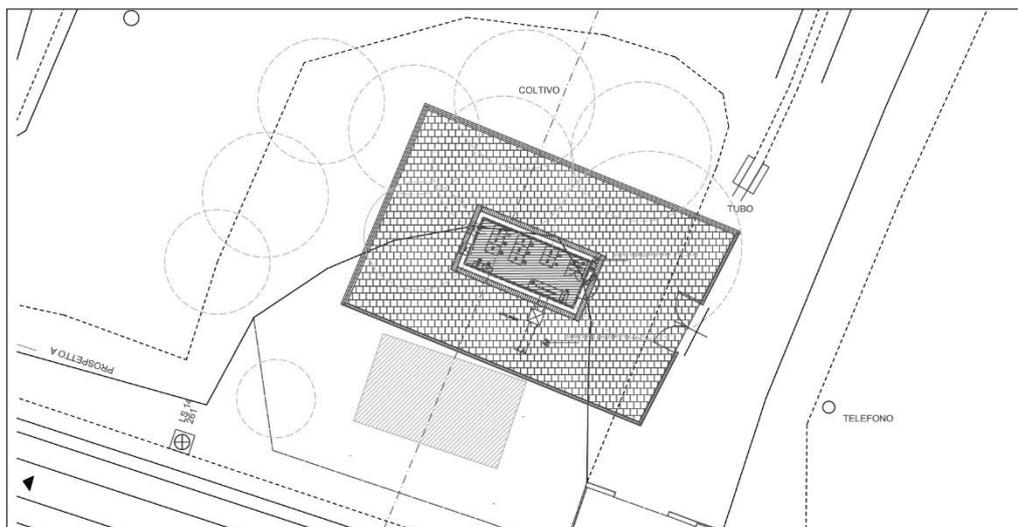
PPT1: planimetria; in grigio scuro le opere a progetto, in grigio chiaro l'edificio da demolire e il profilo delle piante
